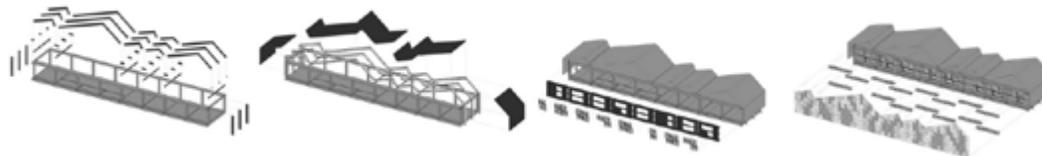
Proceso de montaje de los elementos constructivos de la obra. Autoría: Elaboración propia
